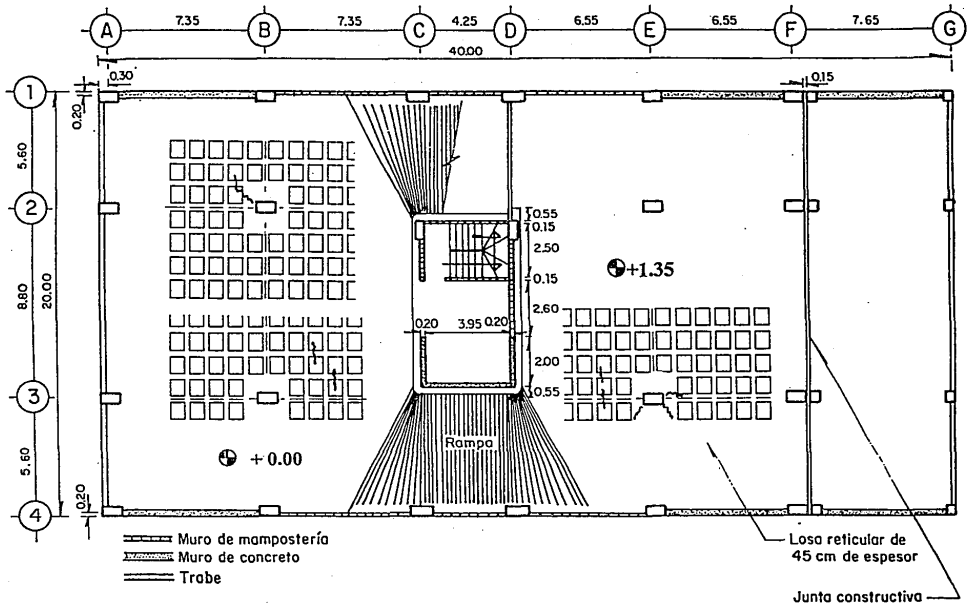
Agrietamientos observados en la losa E3 y E5
